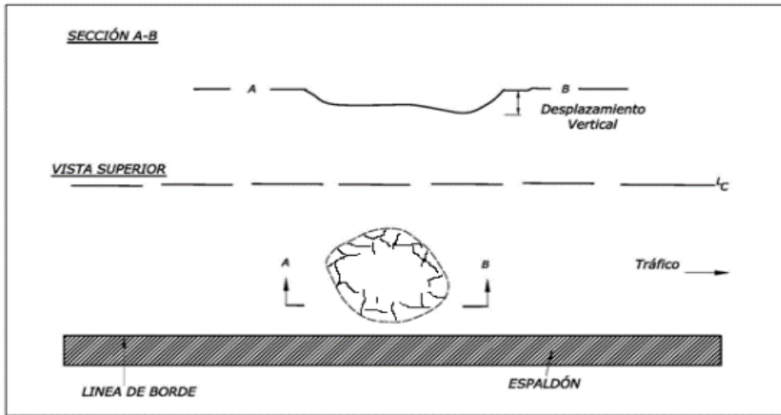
Esquema Depresiones- Pavimento Flexible
